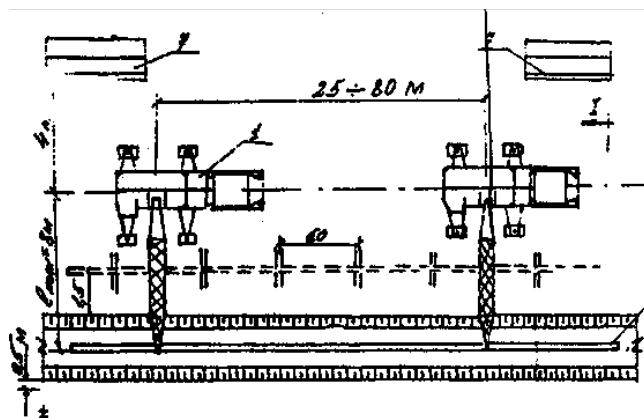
Схема укладки газопровода в траншею автомобильными грузоподъемными кранами
